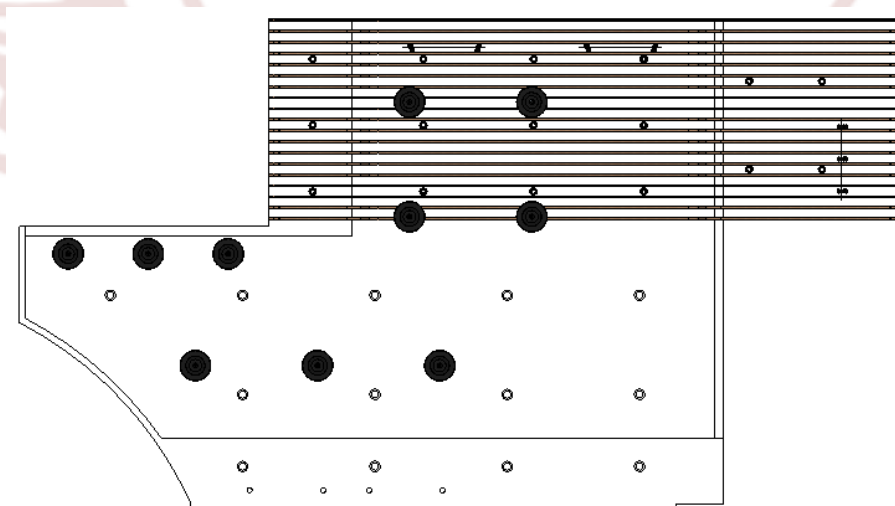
Alternatif 2 Rencana *Ceiling Restaurant
